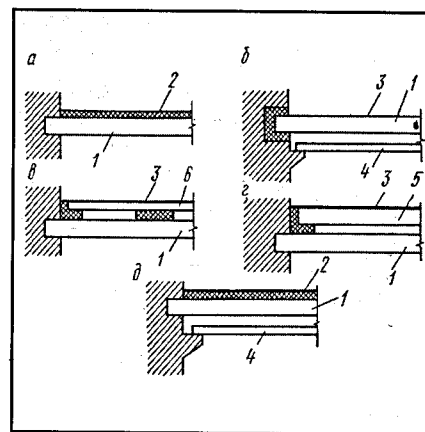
Конструктивні схеми залізобетонних міжповерхових панельних перекриттів: а - з шаруватим перекриттям підлоги; б - з роздільною стелею; в - з роздільною підлогою; г - з двох несучих панелей; д - з шаруватим покриттям підлоги і роздільною стелею; 1 - несуча панель перекриття; 2 - звукоізолююча шарувата підлога; 3 - покриття підлоги; 4 - панель роздільної стелі; 5 - несуча панель підлоги; 6 - панель роздільної підлоги.
